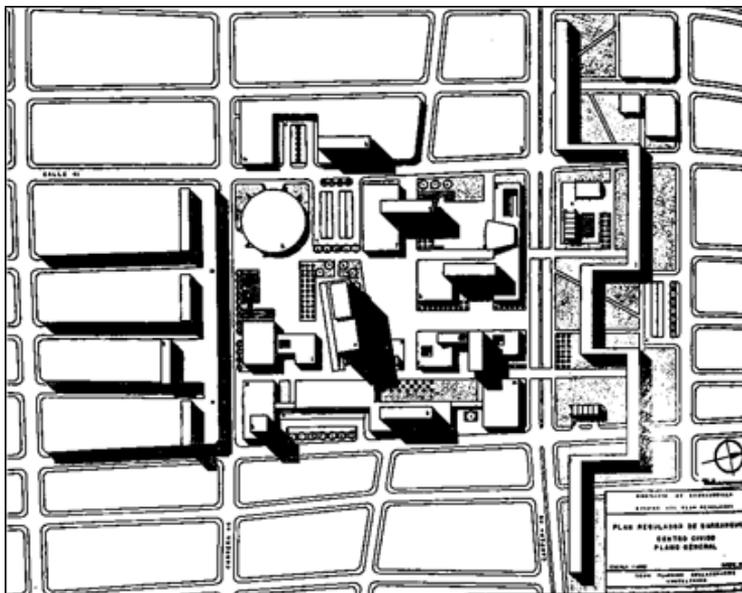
Plano del Proyecto de la firma Town Planning Collaborative para la Oficina del Plan Regulador de Barranquilla en 1953 del Centro Cívico. Fuente: El Movimiento Moderno en Barranquilla 1946 - 1964. Carlos Bell Lemus.
